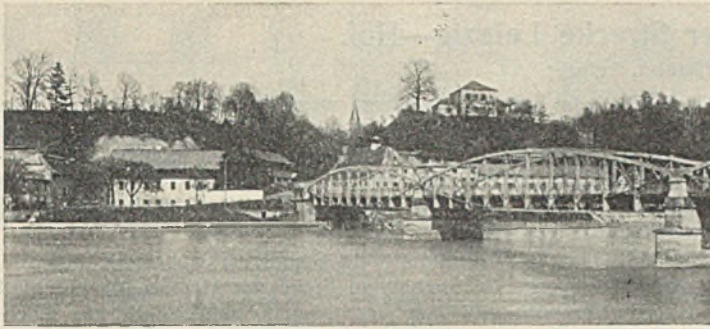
Die alte Schweißisenbrücke aus dem Jahre 1866.
